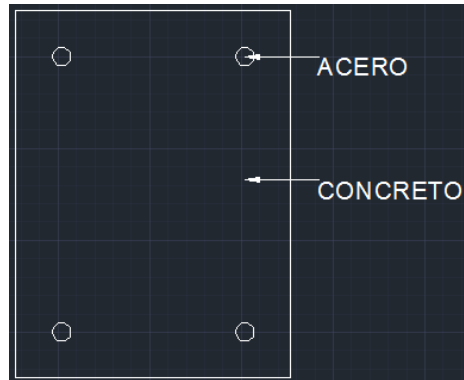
Esquema sección transversal viga de dos materiales (concreto/acero).
